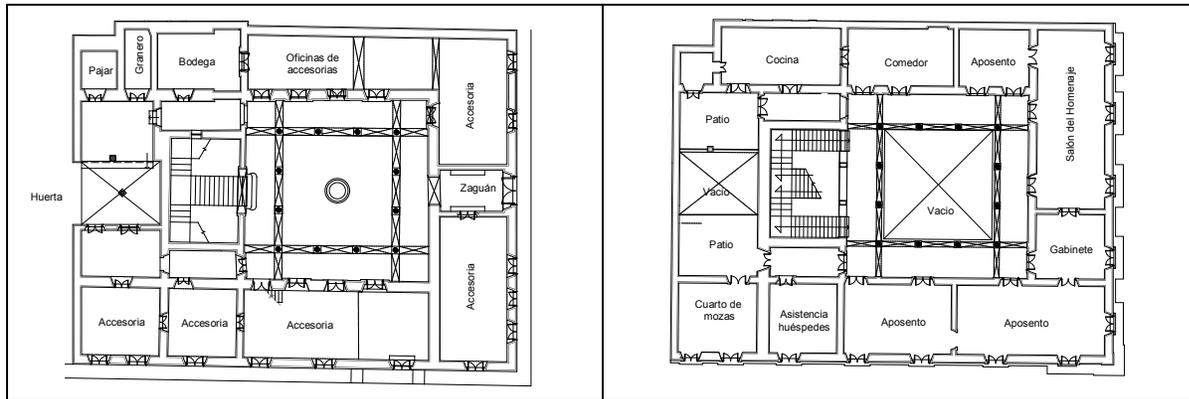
Reconstrucción histórica de la casa habitación de Isidro Huarte en el siglo XVIII, planta baja.
